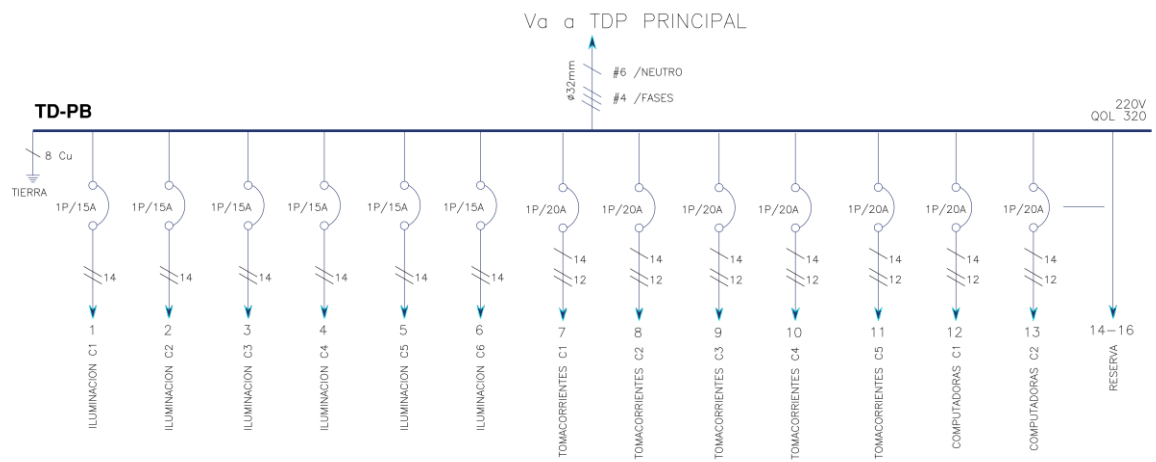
Diagrama unifilar tablero de distribución planta baja. [Autor]
